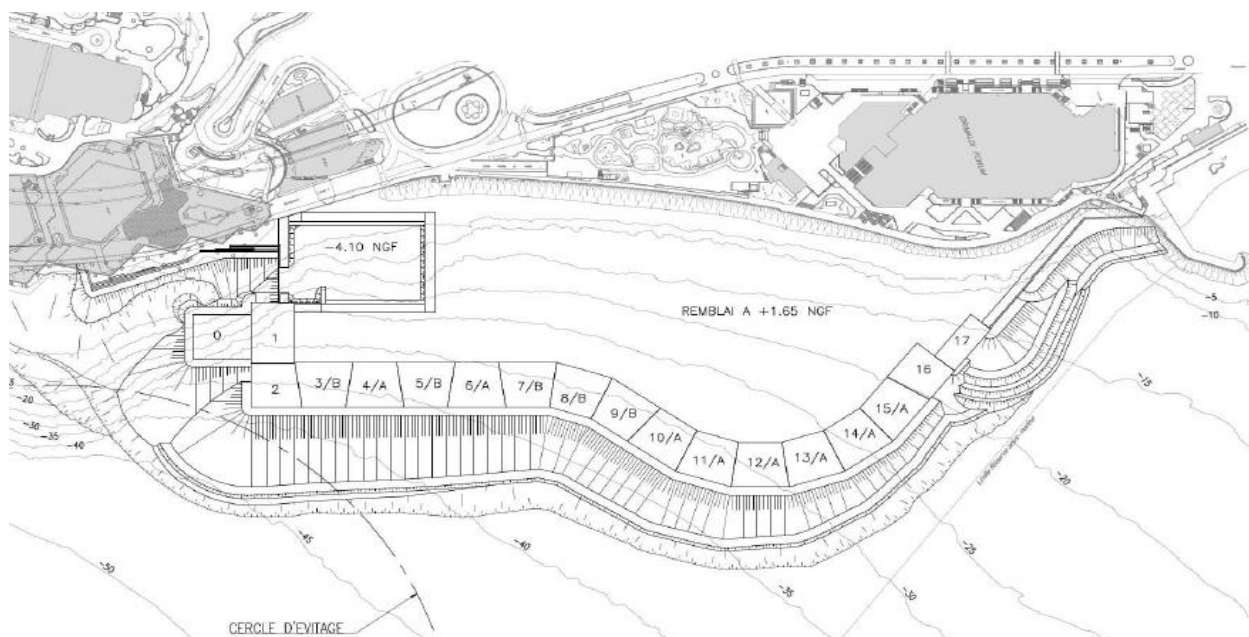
plan de la protection d'un remblai par une ceinture de caissons.
